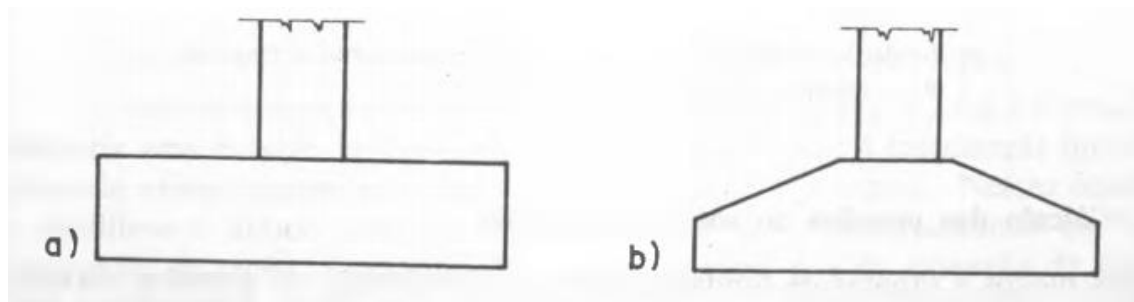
Tipos de sapatas de fundação em concreto armado: a) altura constante; b) altura variável.
